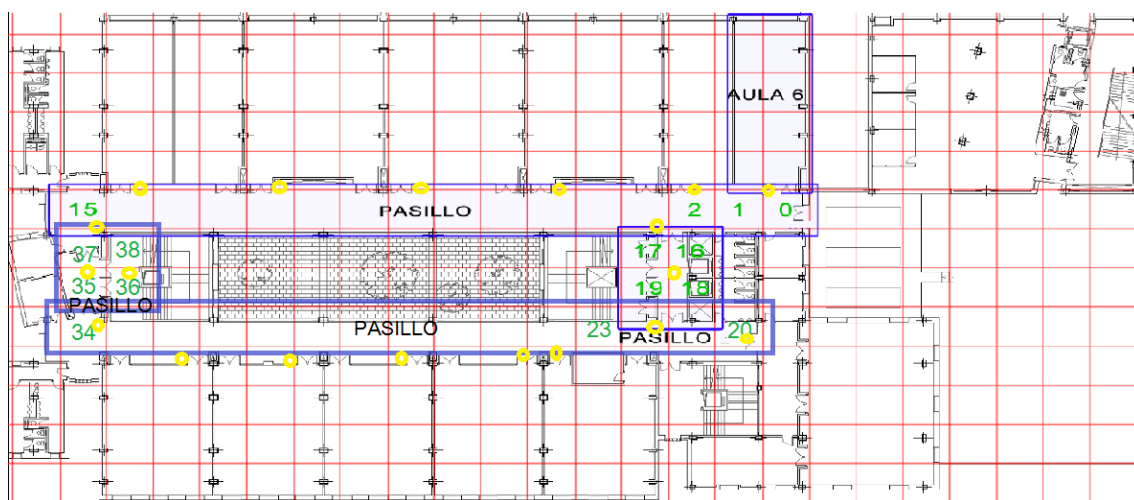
Primera versión del mapeo de la primera planta de la Facultad de Informática.
